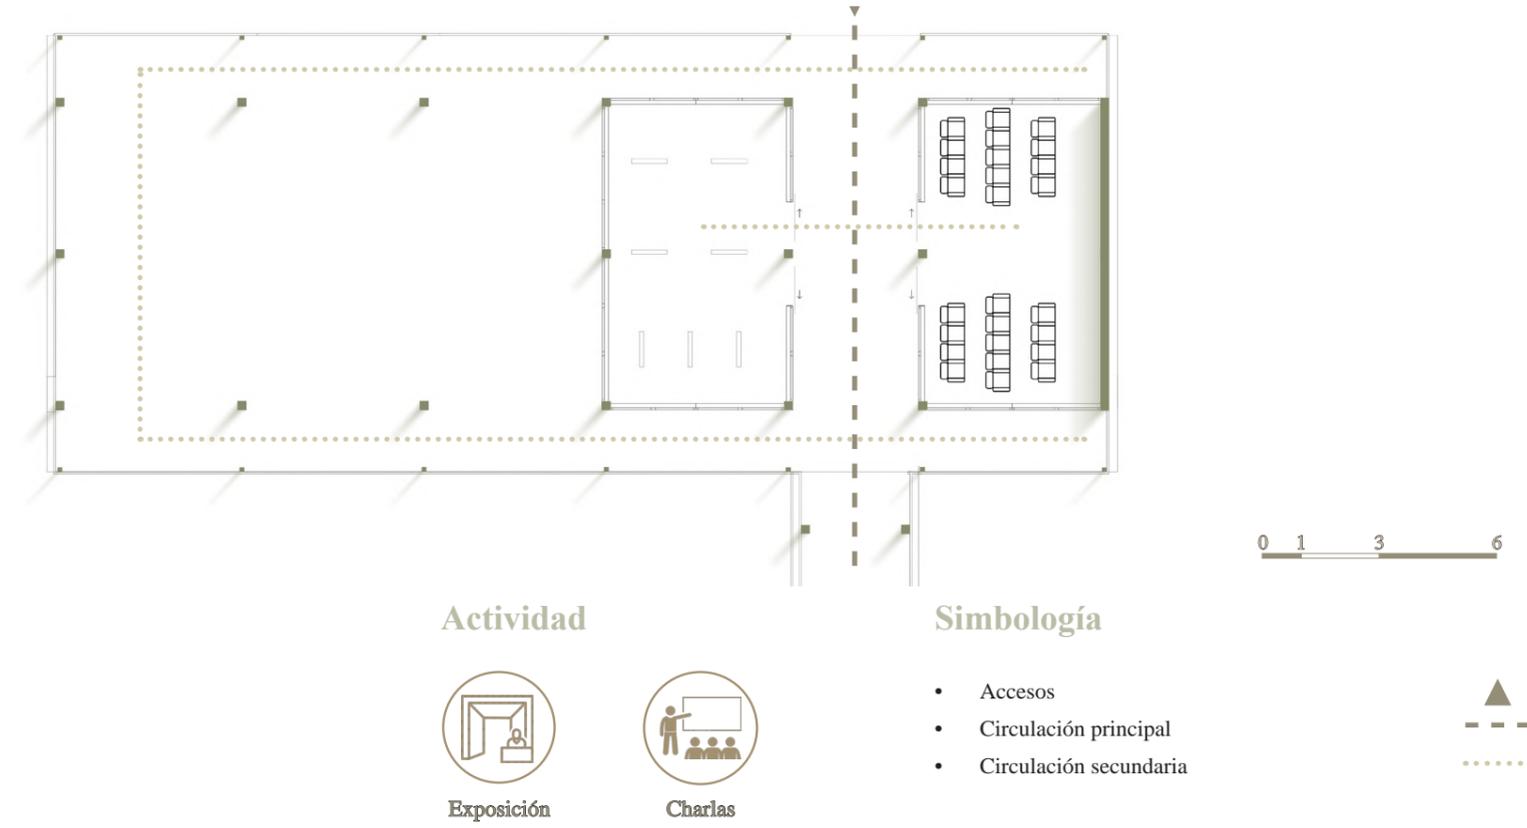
Planta del pabellón de conexión, Autoría propia, 2025
